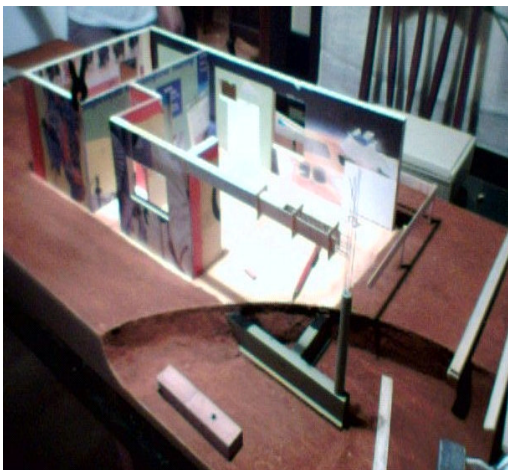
Miniatura ainda em execução apresentando parte do gabarito de locação da fundação em vigas com um pilar, uma viga em construção e paredes.
